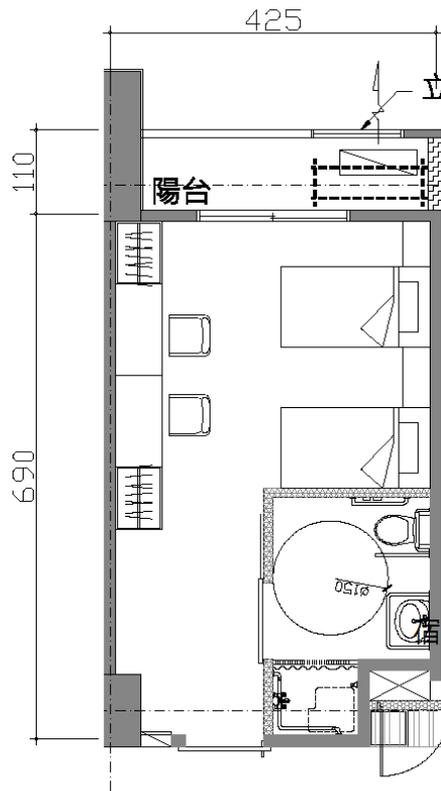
、南棟 2 人寢室單元平面圖(註:本圖僅示意參考,仍依實際設計為準)
